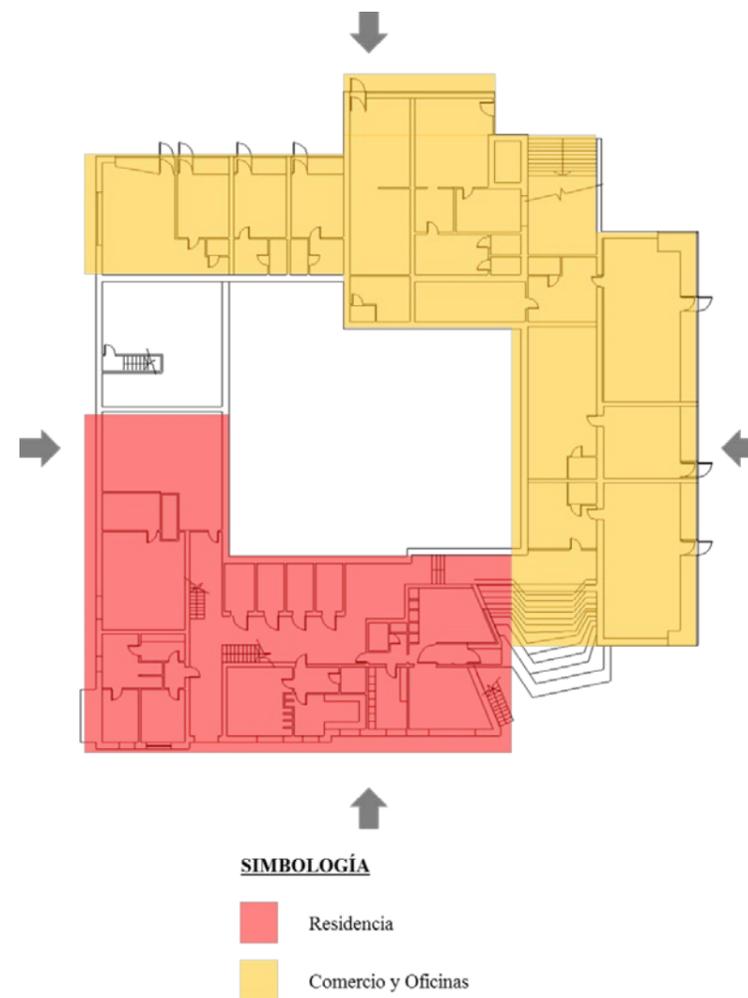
Ayuntamiento Saynatsalo - Distribución espacial de planta baja.
